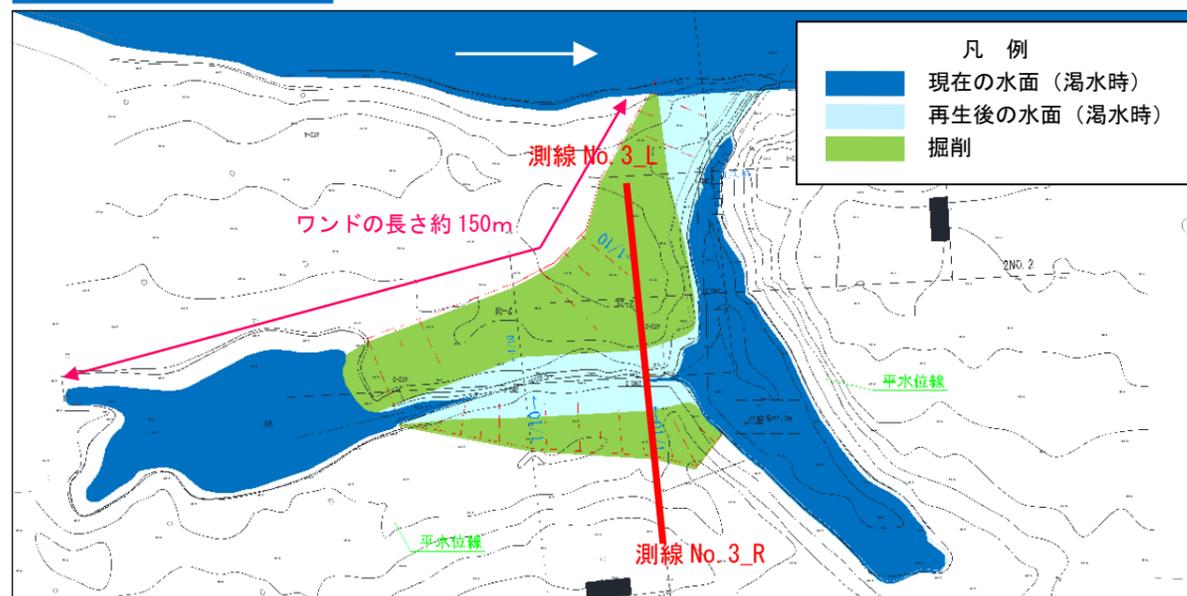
水ヶ曽根地区ワンドの計画平面図
